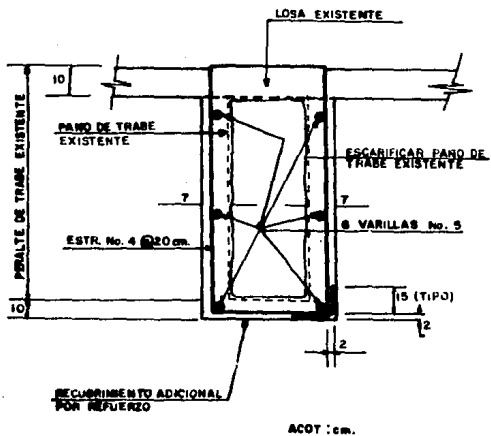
ENCAMISADO TIPOICO DE TRABES
